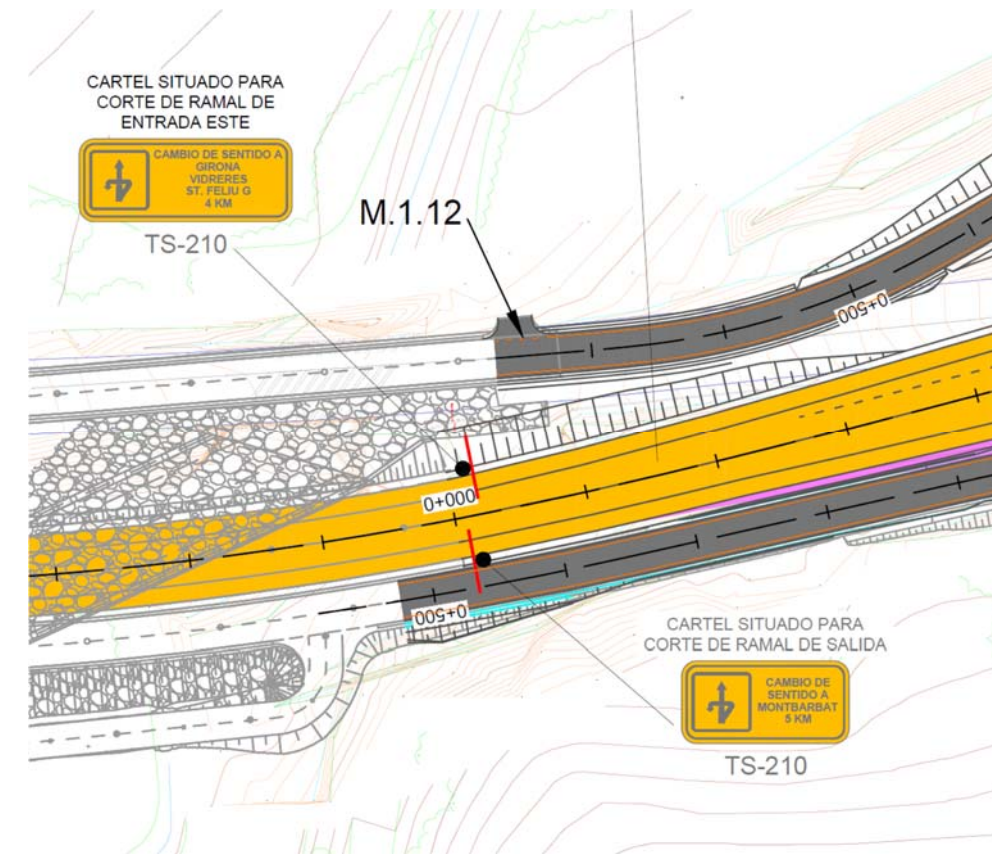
Detalle de desvíos para la pavimentación de los ramales del Enlace en el inicio de las obras
